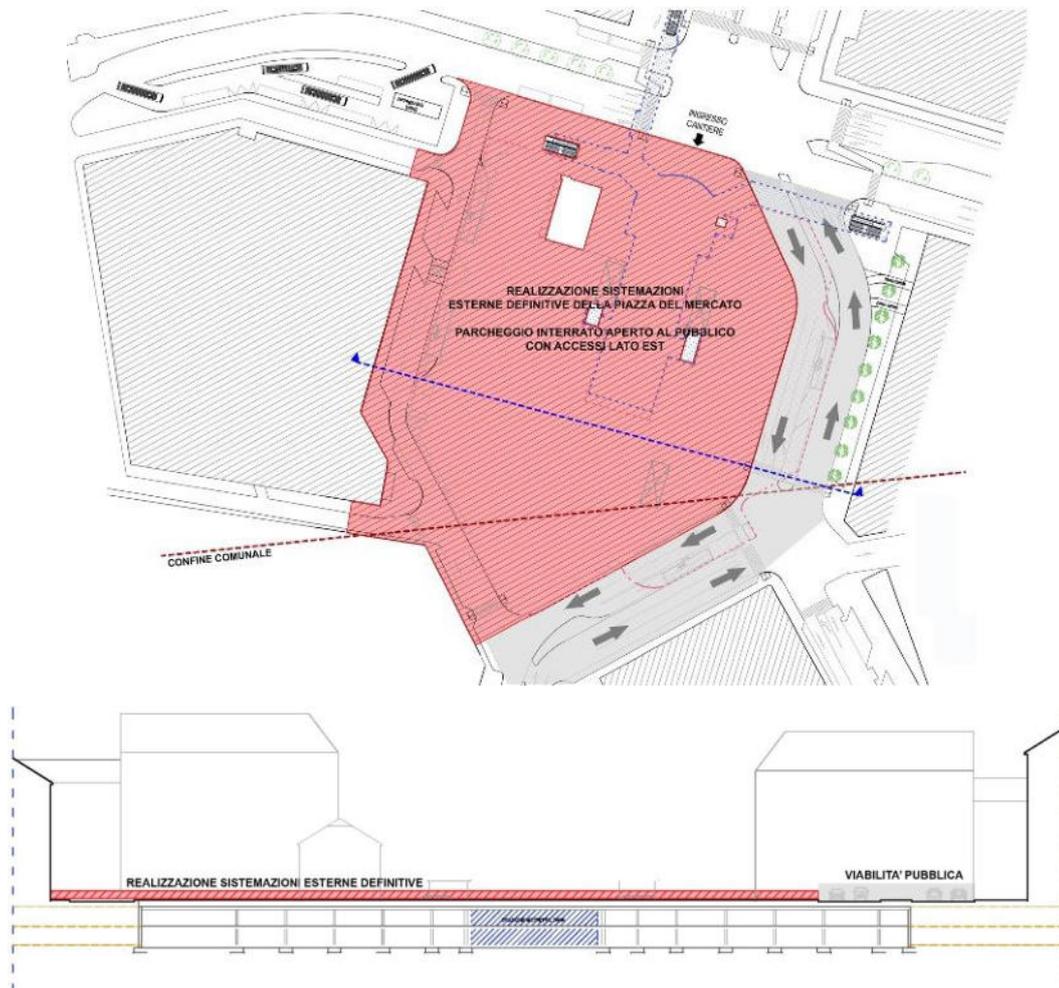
Pianta e sezione dell'organizzazione di layout per la Fase 3
